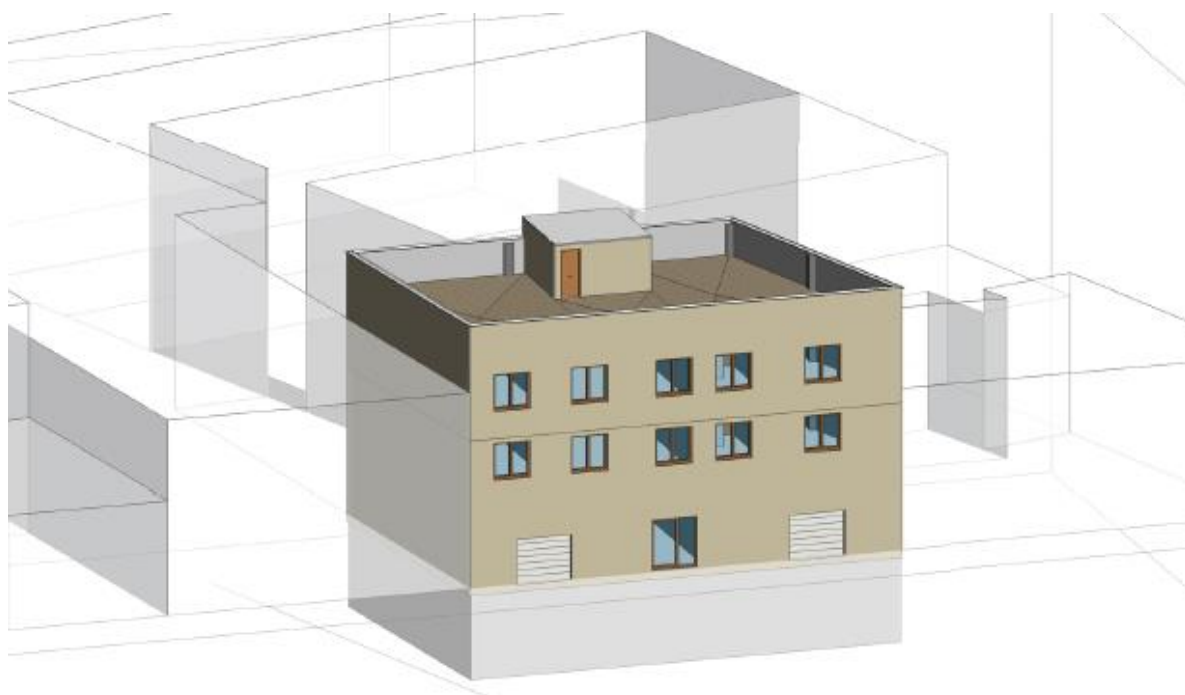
Levantamiento 3D. Fuente: Propia (2019)
